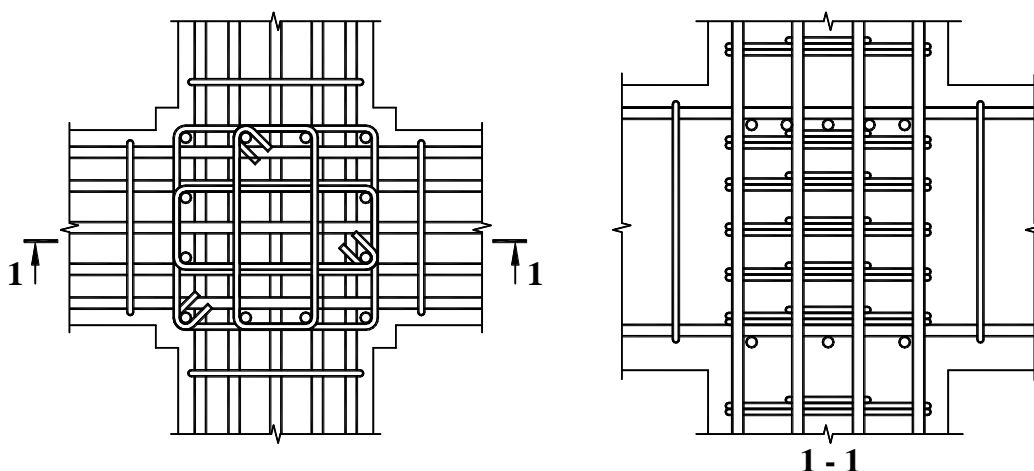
Принципиальная схема армирования соединения балка-колонна при примыкании балок к колонне с четырех сторон
